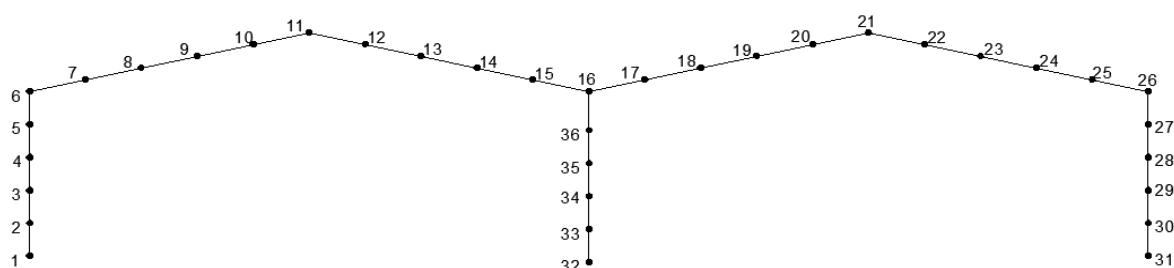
Discretização de um pórtico em elementos finitos de barra
